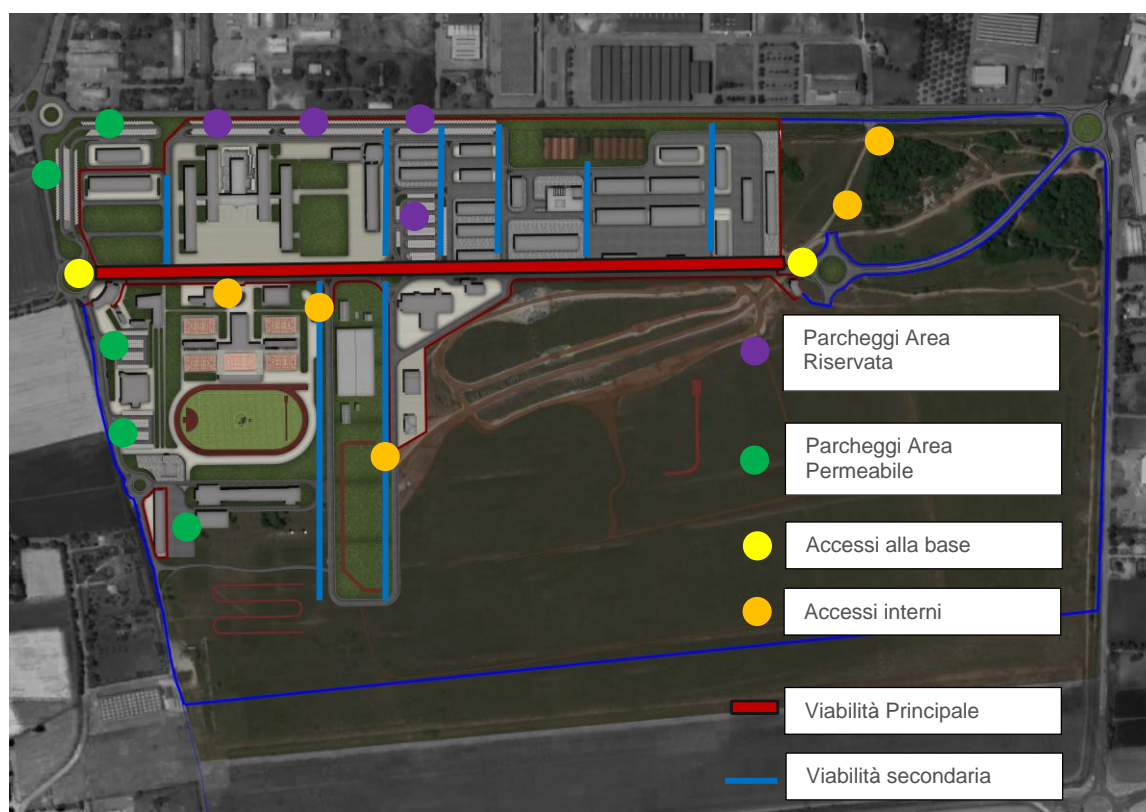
Planimetria generale di progetto. Viabilità, parcheggi ed accessi
